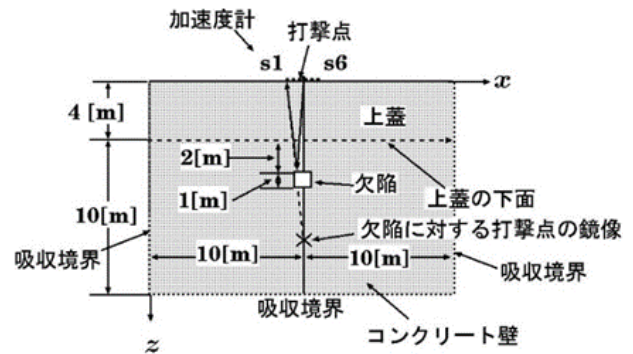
側壁に欠陥のあるコンクリート構造体（上蓋の厚さ：4 m）
